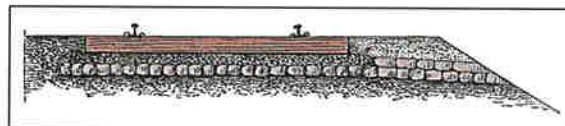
, échelle du plan : 15/1000. Profil de la voie allemande.
